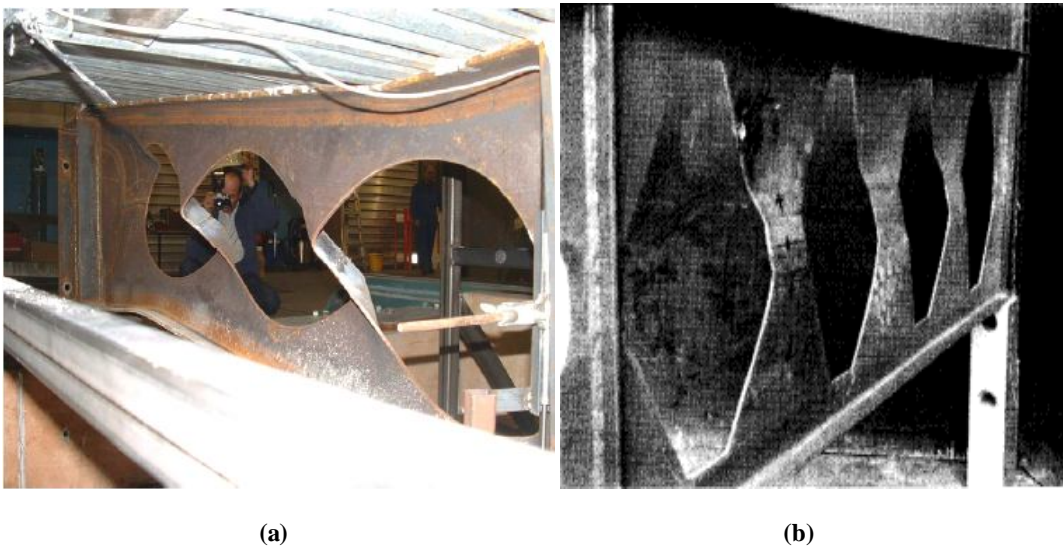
Flambagem do montante de alma de viga alveolar (a) celular (NADJAI *et al.*, 2008); (b) castelada (ZAAROUR E REDWOOD, 1996).
